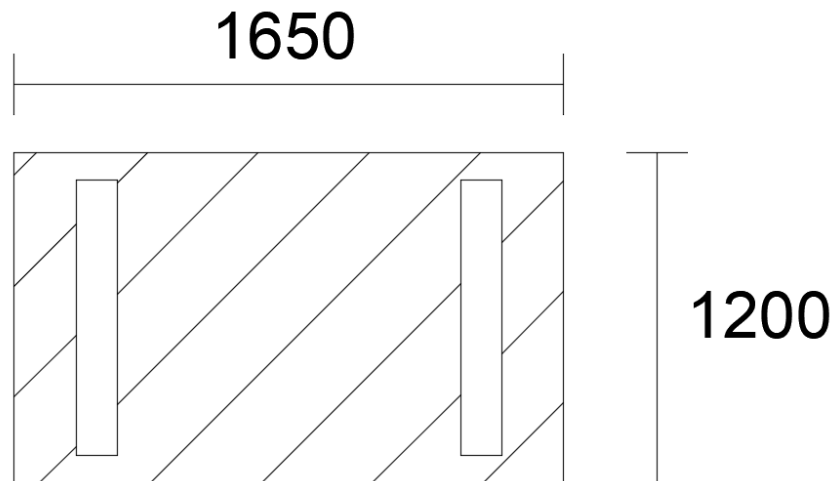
Losa depósito Muelle Ciego, vista planta- Fuente: propia.
